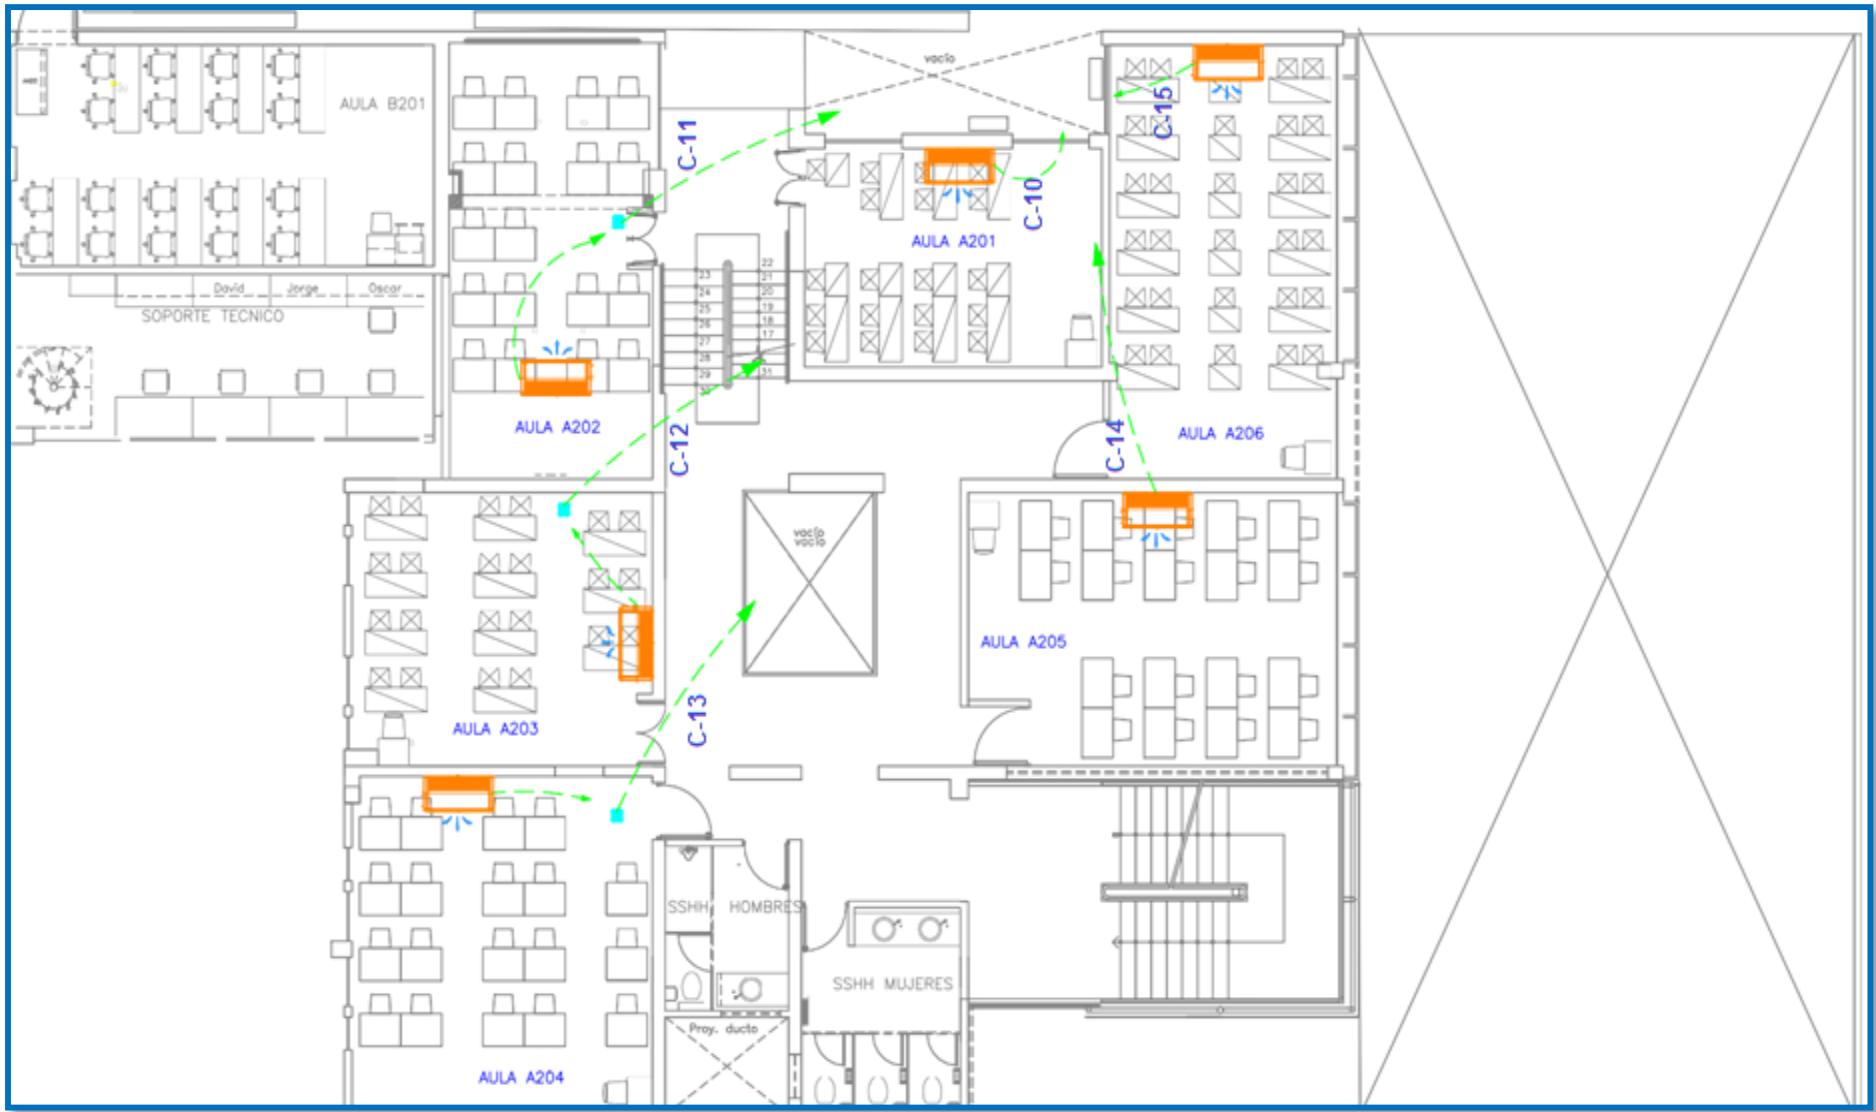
Plano de la segunda planta – Instituto Privado Toulouse Lautrec
